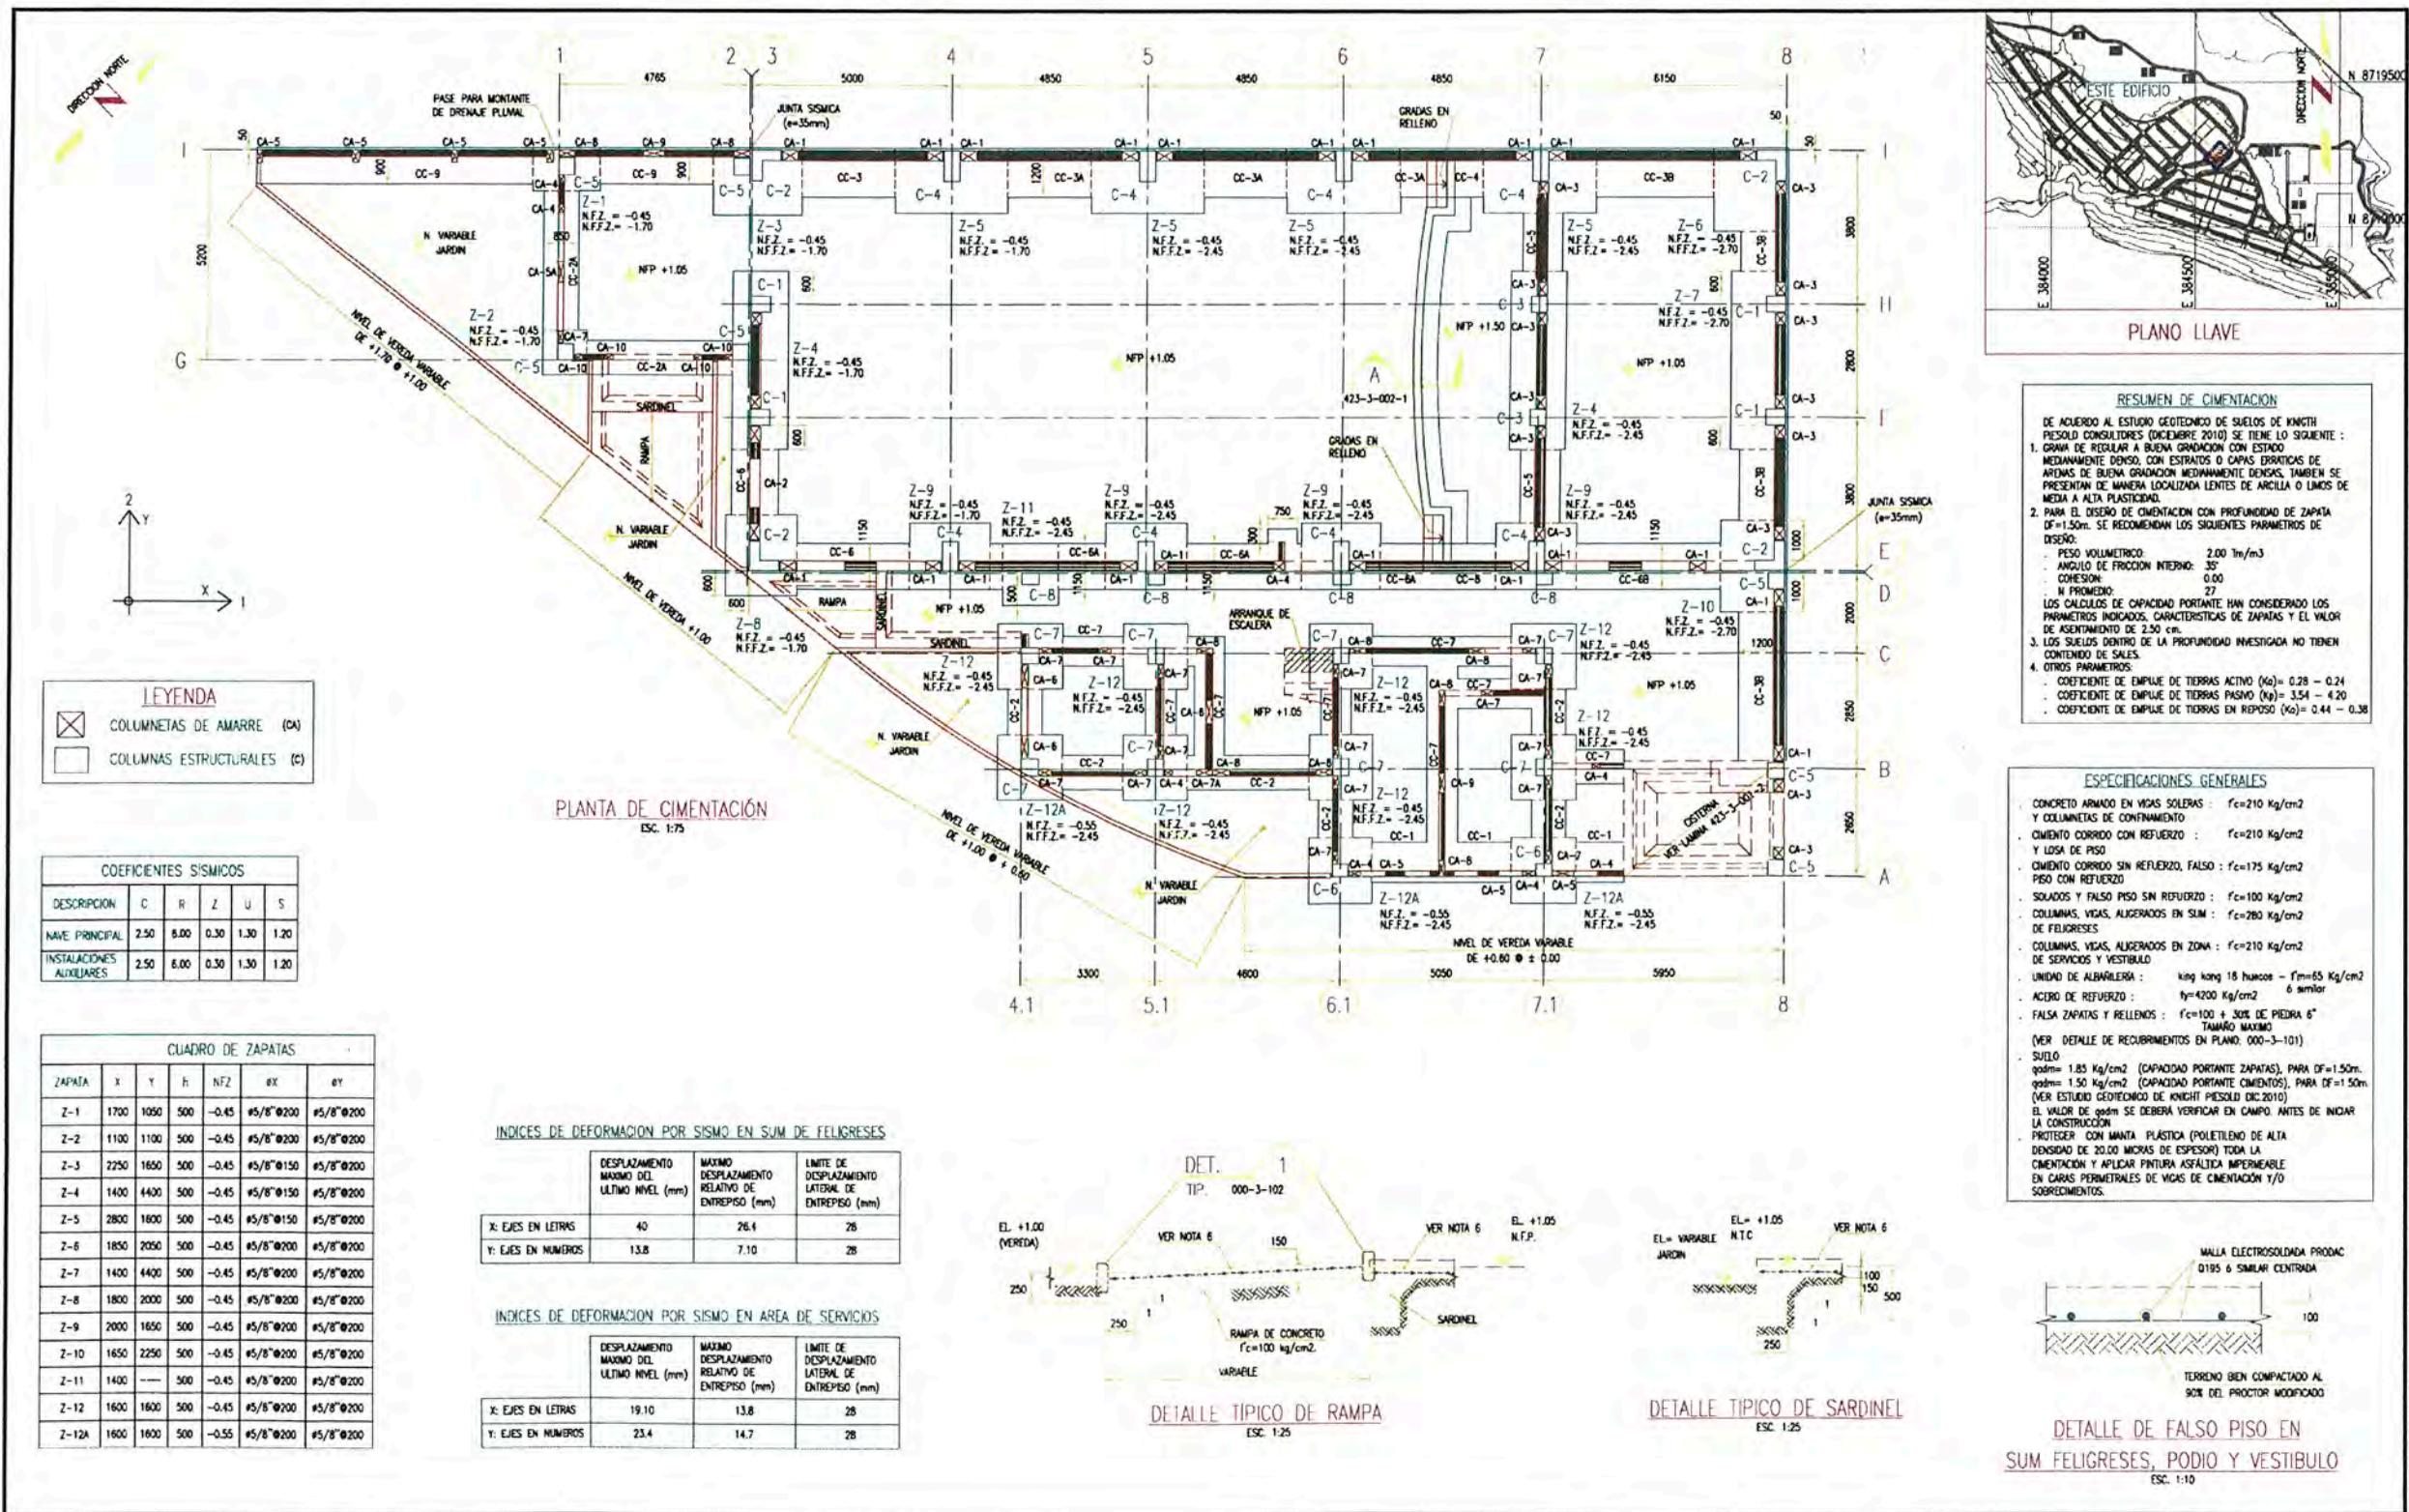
Plano de Estructuras, cimentación de Iglesia Evangélica
